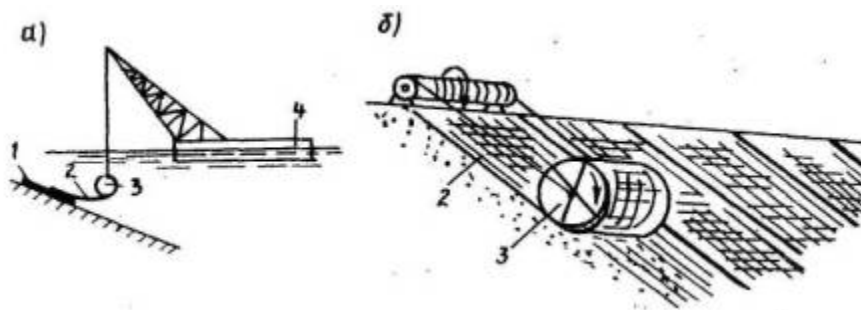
Укладка на откос сборного асфальтобетонного покрытия с барабана: а-подводная часть покрытия; б-размотка тьюфа с барабана; 1,2-асфальтобетонные тьюфы; 3-барабан; 4-плавучий кран
